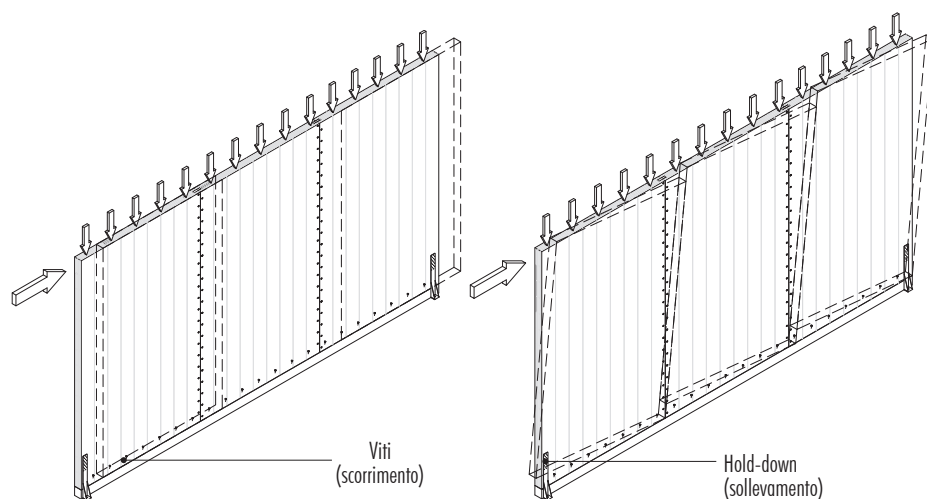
Parete Xlam soggetta ad azioni orizzontali nel piano. Le azioni di scorrimento e sollevamento vengono contrastate mediante viti inclinate collegate al cordolo di larice e hold-down.
